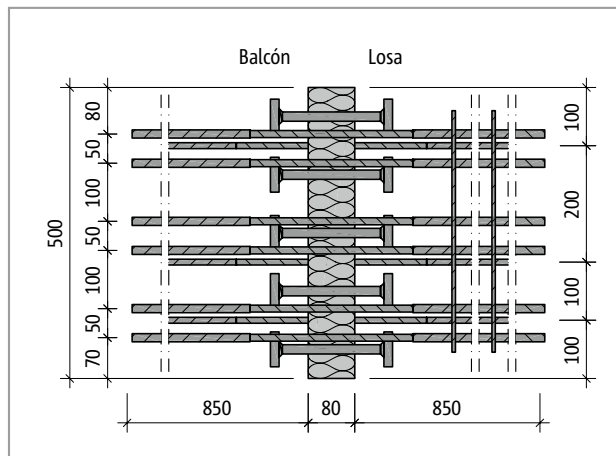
Schöck Isokorb® T tipo K-M12-V1: Plano del producto
